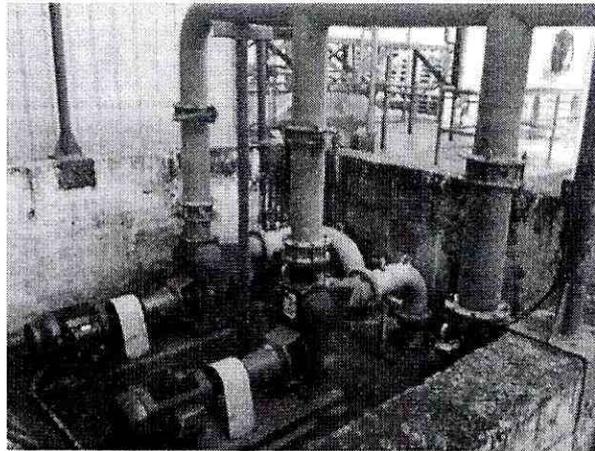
Vista de bombas de planta elevadora N°1 (UTM 18 S 688.404 E; 5.585.746 S)
